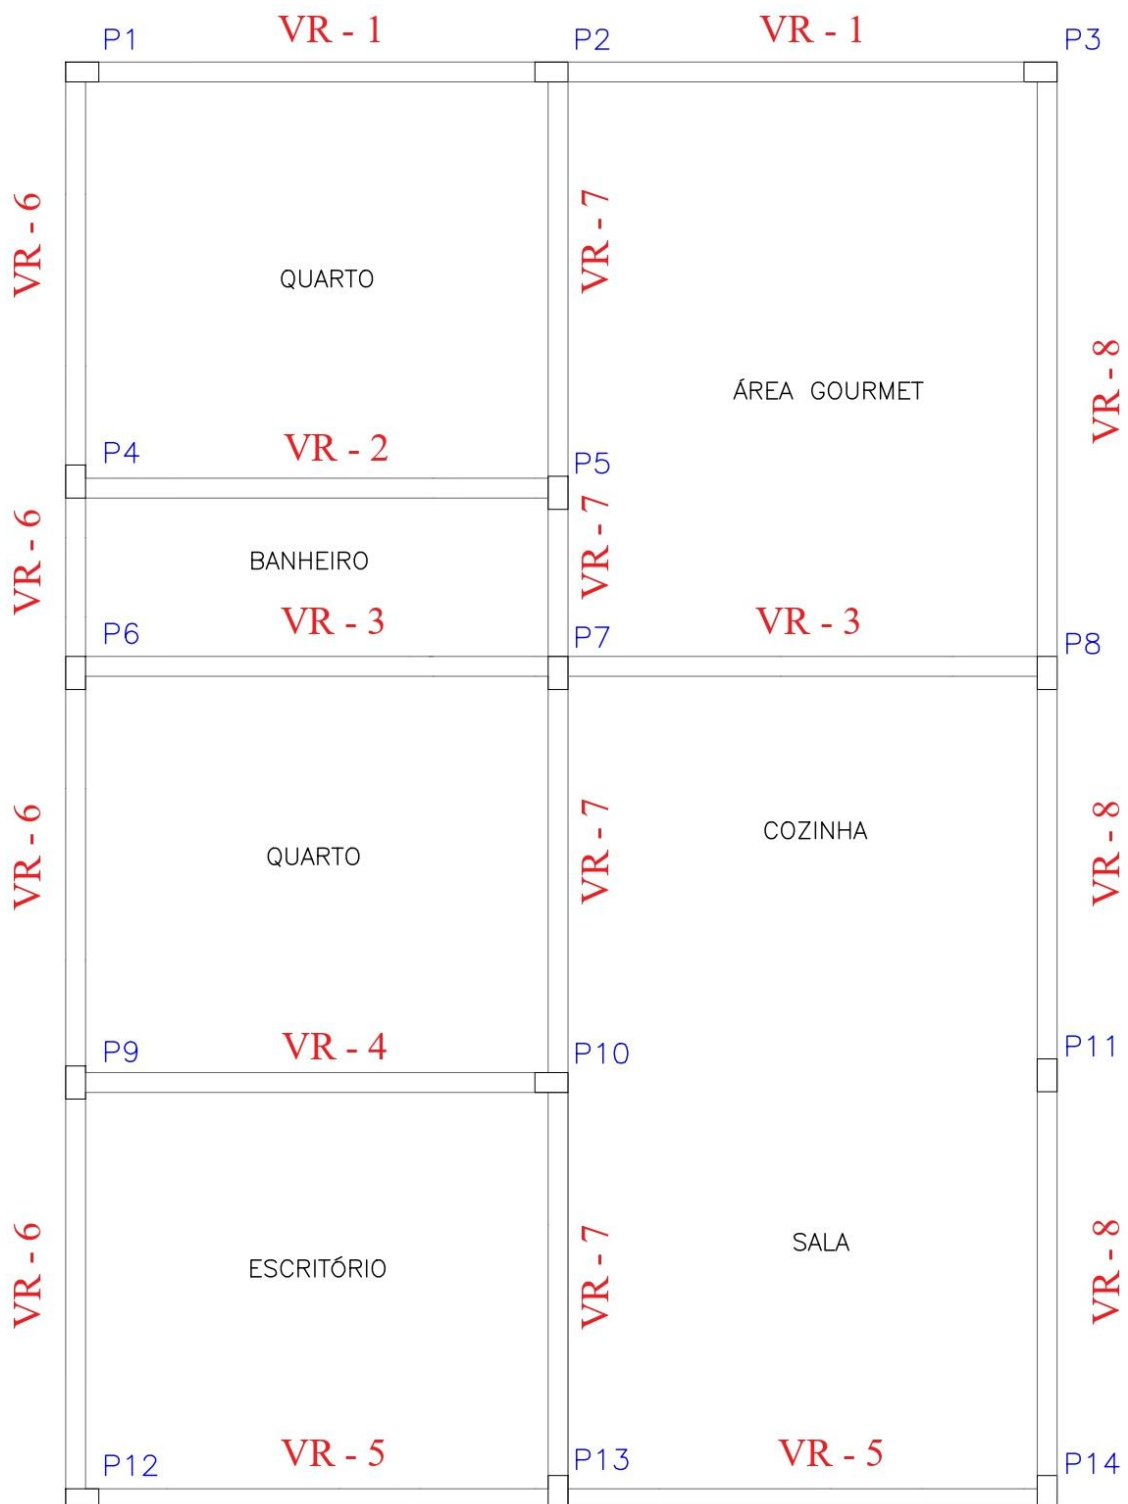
Planta Baixa – Nível Respaldo do Projeto Base
